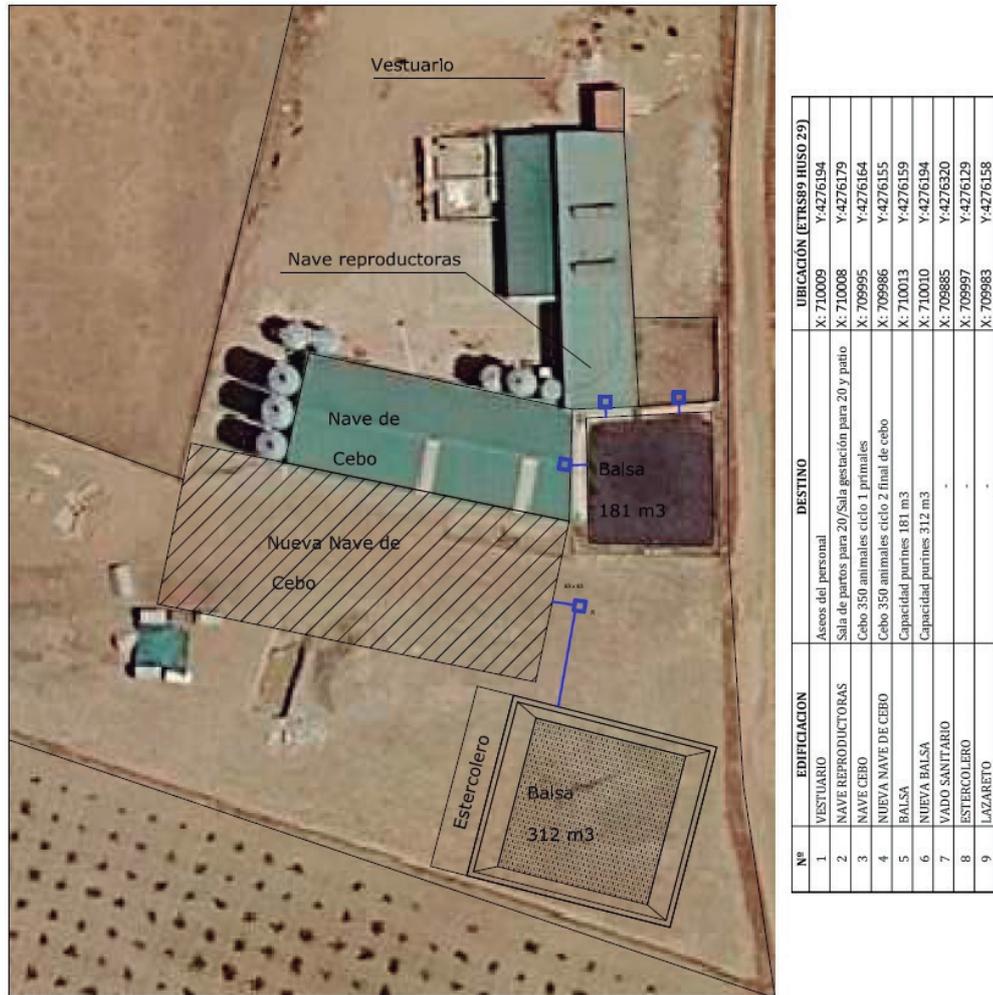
Planta general de las instalaciones, con detalles de las coordenadas geográficas.
